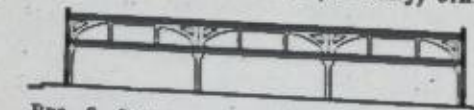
Схема одноэтажного производственного здания с межферменными этажами в перекрытиях из бесраскосных ферм арочного типа.
